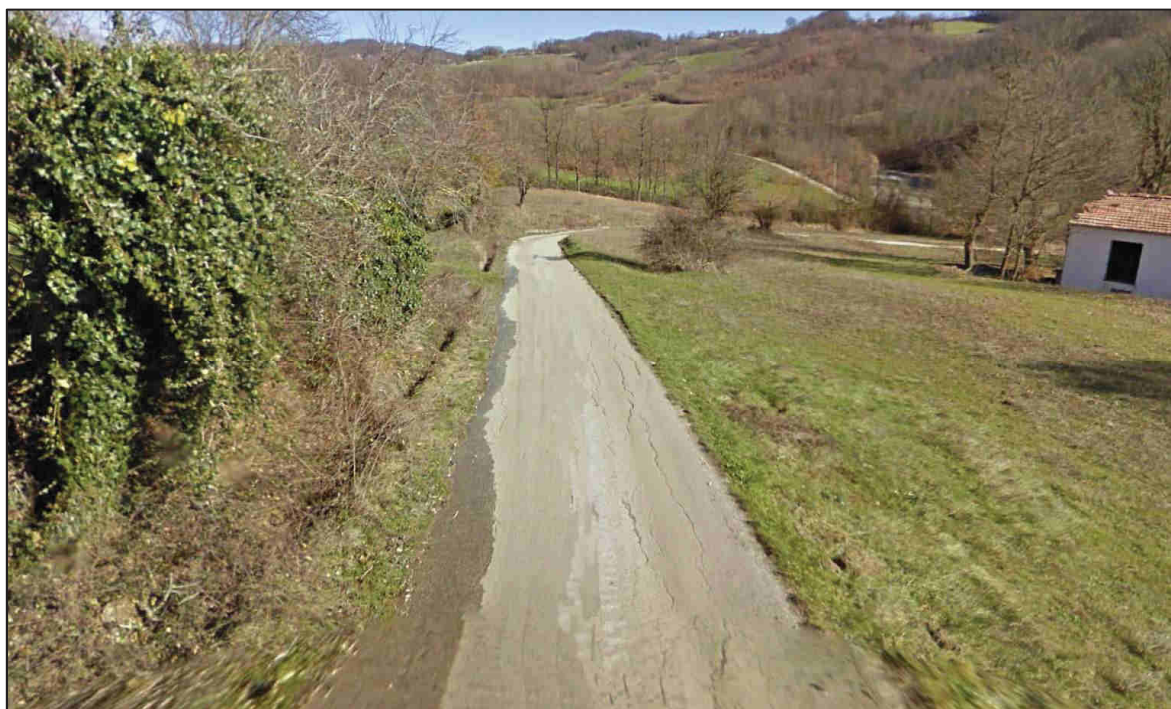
Tracciato cavidotto ricadente nella fascia di 150 metri dal Torrente “Torti”.
